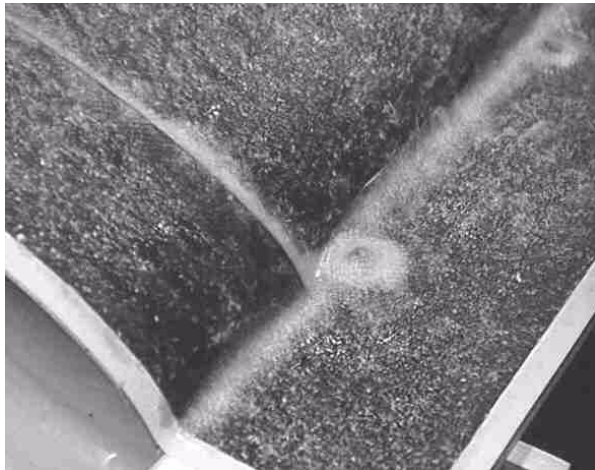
Die abgerundeten Kanten vor dem Laminieren der Isolierung
